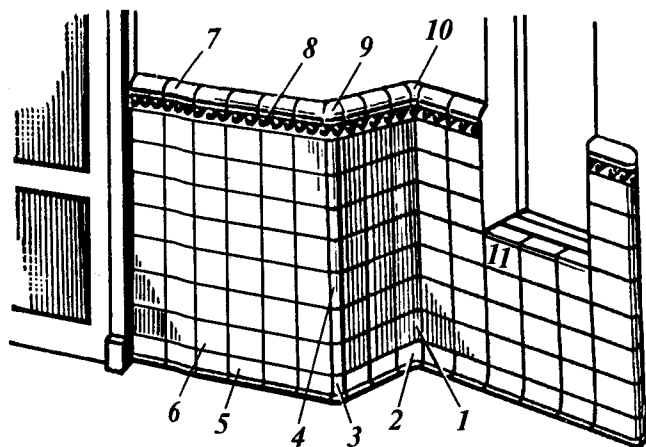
Облицовка стен глазурованными плитками: 1 — внутренний уголок; 2,3 — плитусовые уголки; 4 — внешний уголок; 5 — плитусовая плитка; 6 — квадратная рядовая плитка; 7 — карнизная плитка; 8 — поясok; 9,10 — уголки карниза; 11 — плитка со скругленной кромкой (с завалом)
